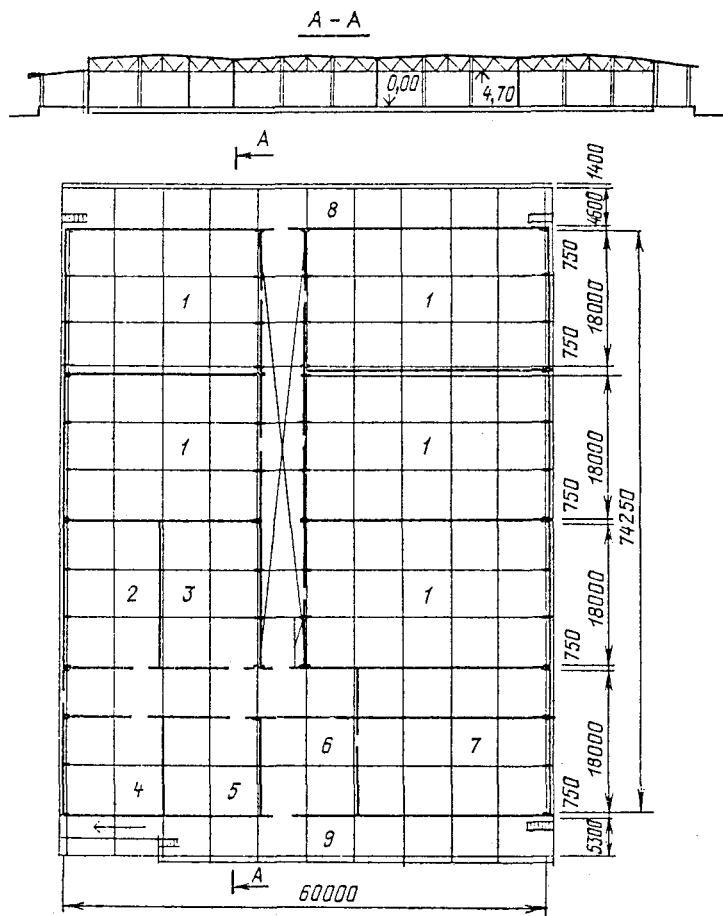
Схема плана сырохранилища на 1000т единовременного хранения (легкие металлические конструкции):
